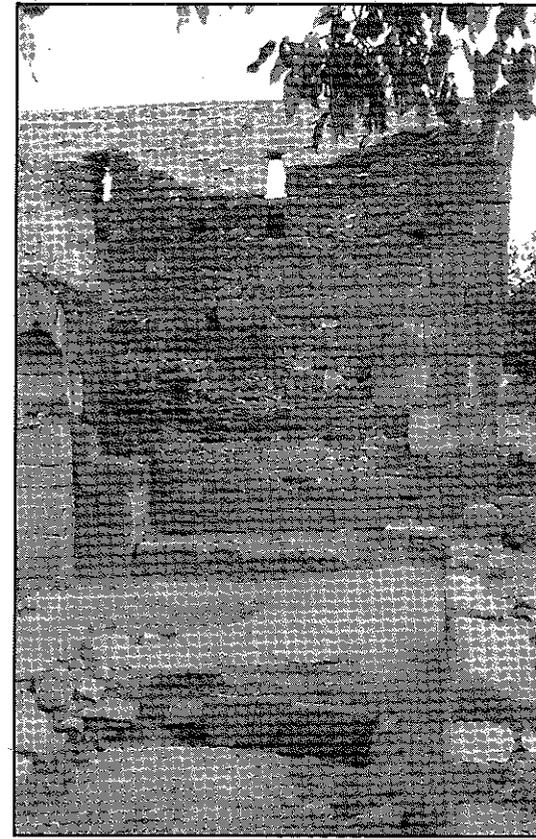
Sta. Lucía del Trampal. Aparejo de mampostería reforzada con sillería reutilizada. Muro septentrional del aula. Cadenas y verdugadas de sillería, verdugadas de ladrillo, mechinales de andamios, pilastras de arcos adosados y ventanas.
